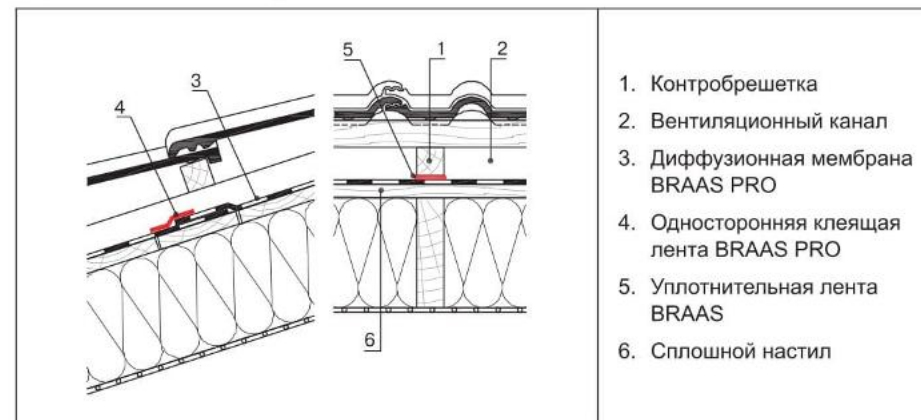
Кровля с малым уклоном, со сплошным настилом, с двумя вентиляционными каналами
